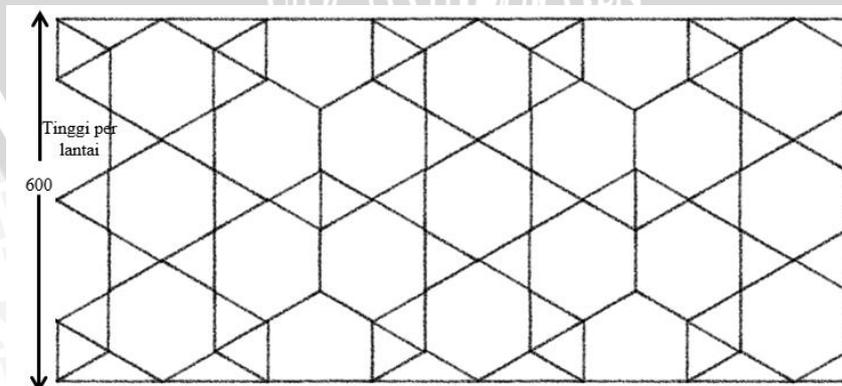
Alternatif dimensi panel 1 (100cm)
